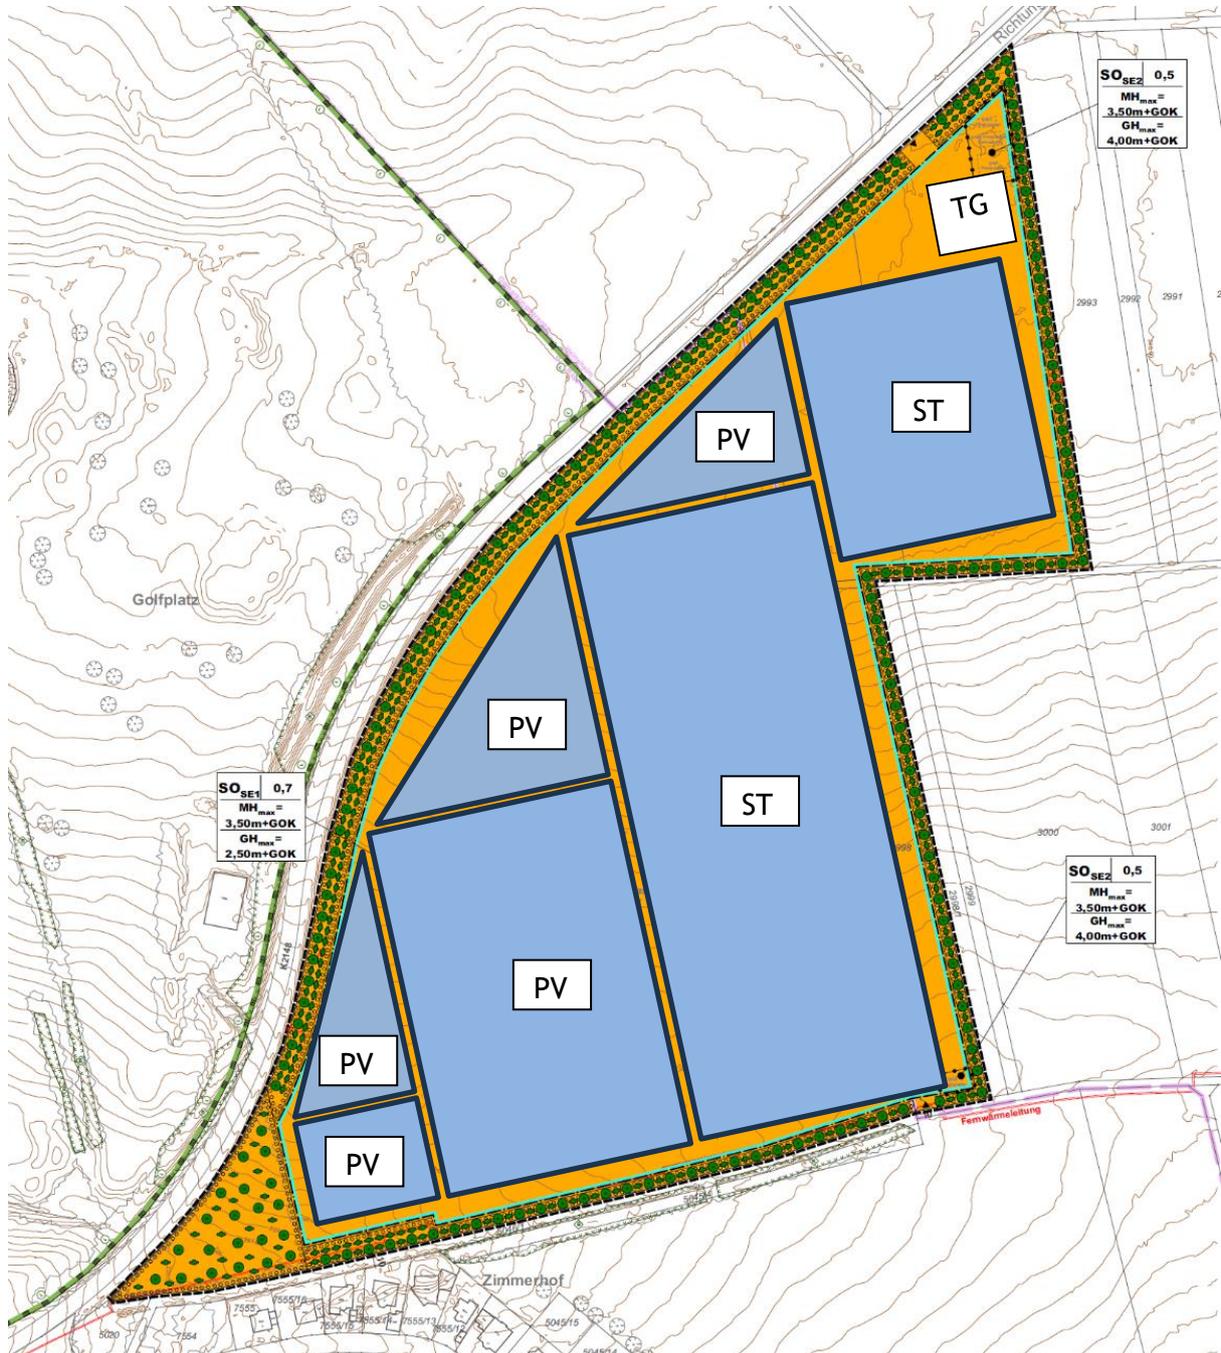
Lageplan zu "Solaranlage Kiesgrubenäcker"
